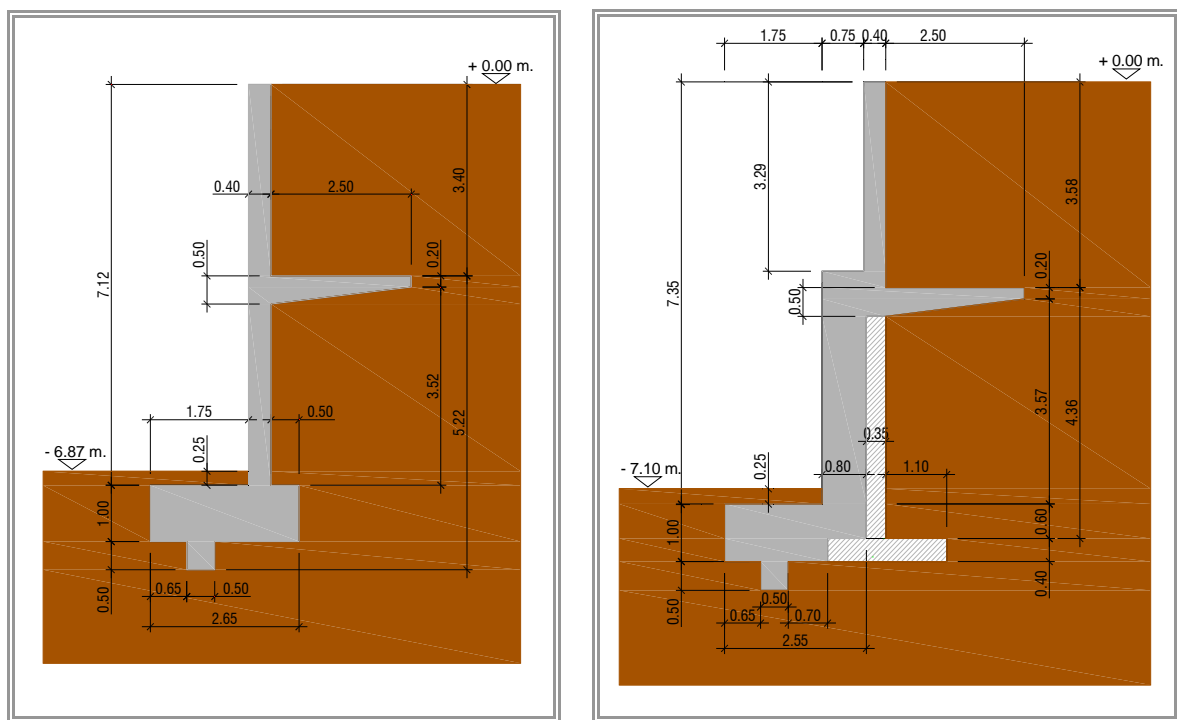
Solución 1. Muro de nueva construcción. Figura 11.10. Muro Solución 2. Adosado al preexistente
